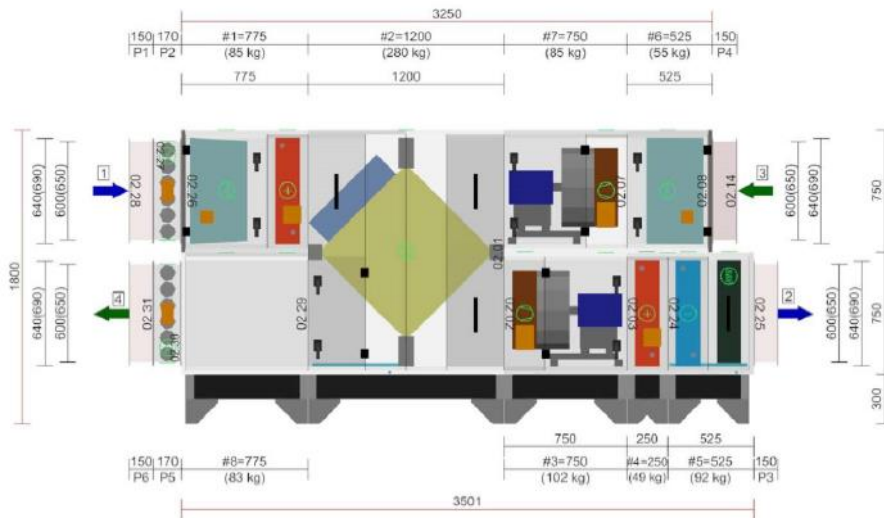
Vzduchotechnické zařízení č. 2 – základní informace, axonometrický pohled
